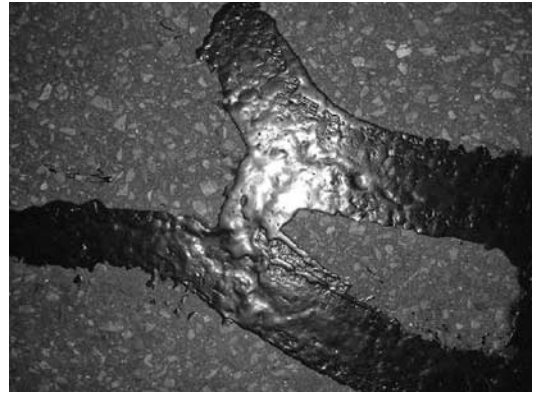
ひび割れに注入したシール材（施工直後）
